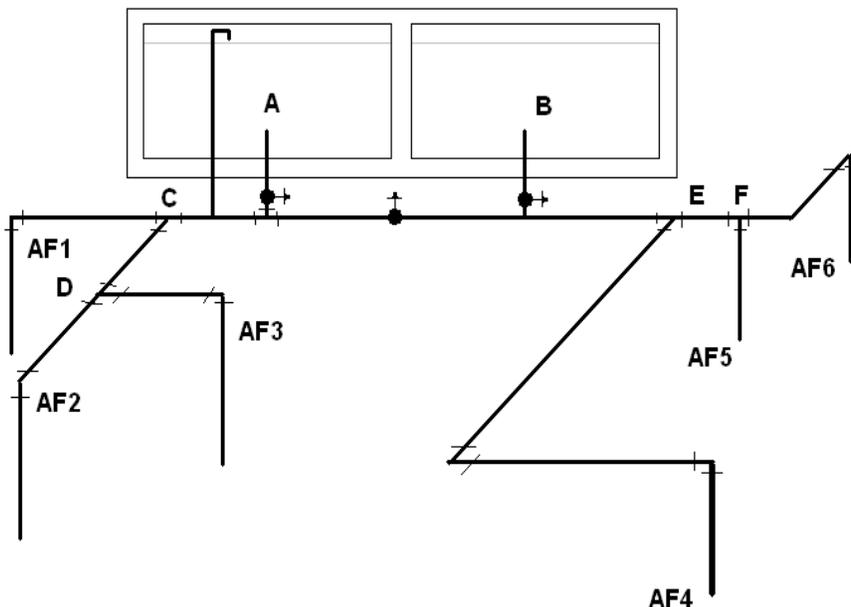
Barrilete Concentrado do Exemplo.
